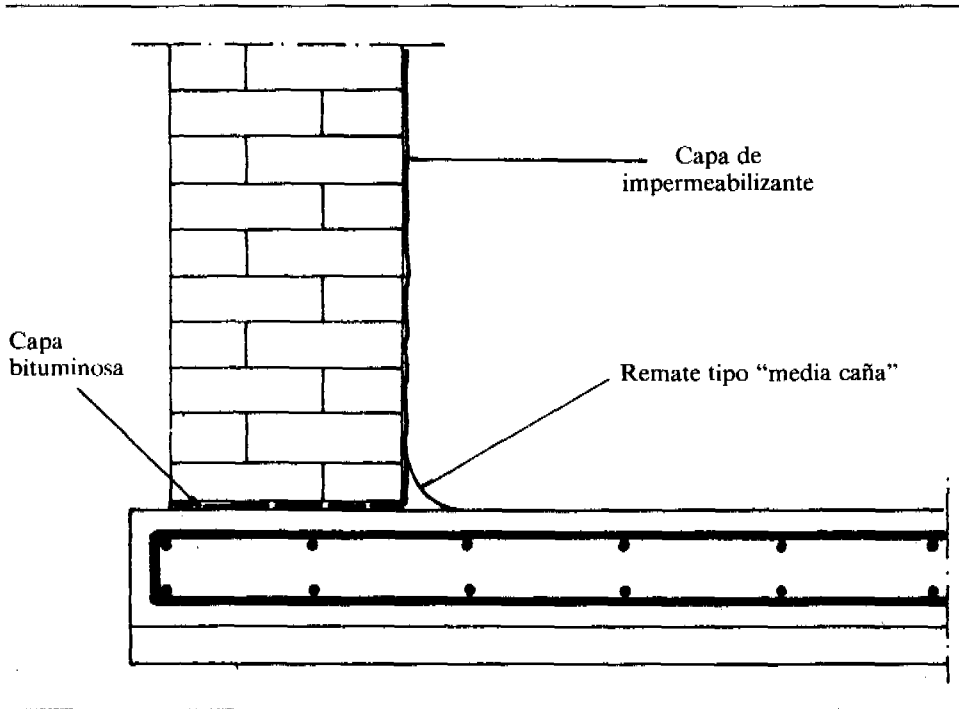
Conexión de la pared y el piso en mampostería y hormigón reforzado.
